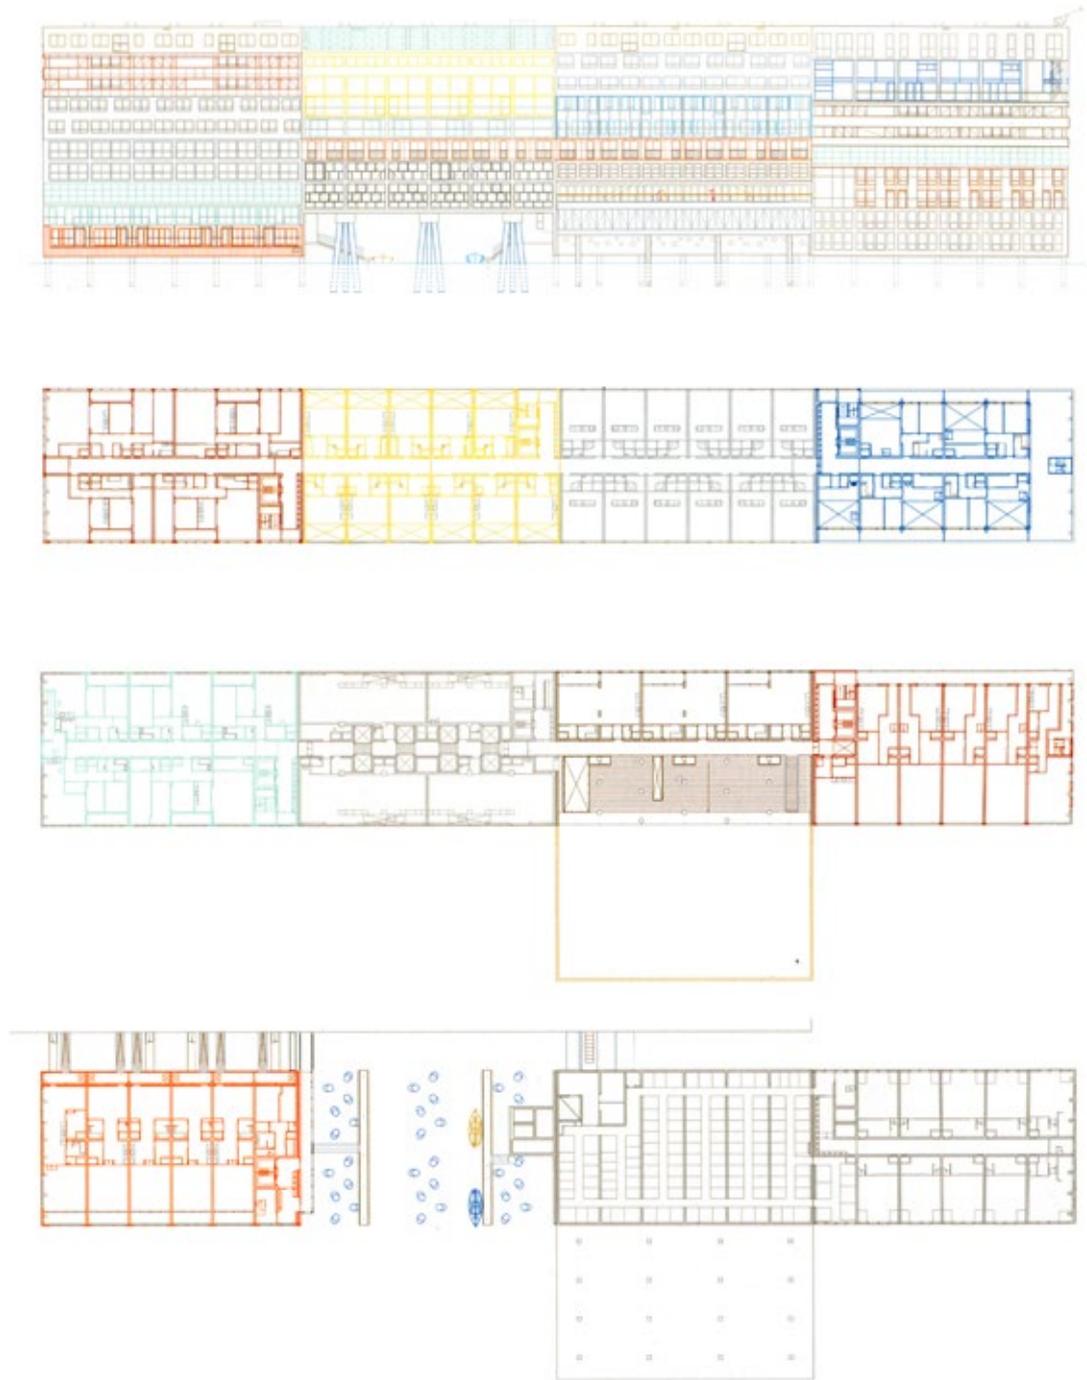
| Plantas y fachada. Fuente: *MVRDV Buildings* (Ruby y Ruby, 2013:55 y 84).
